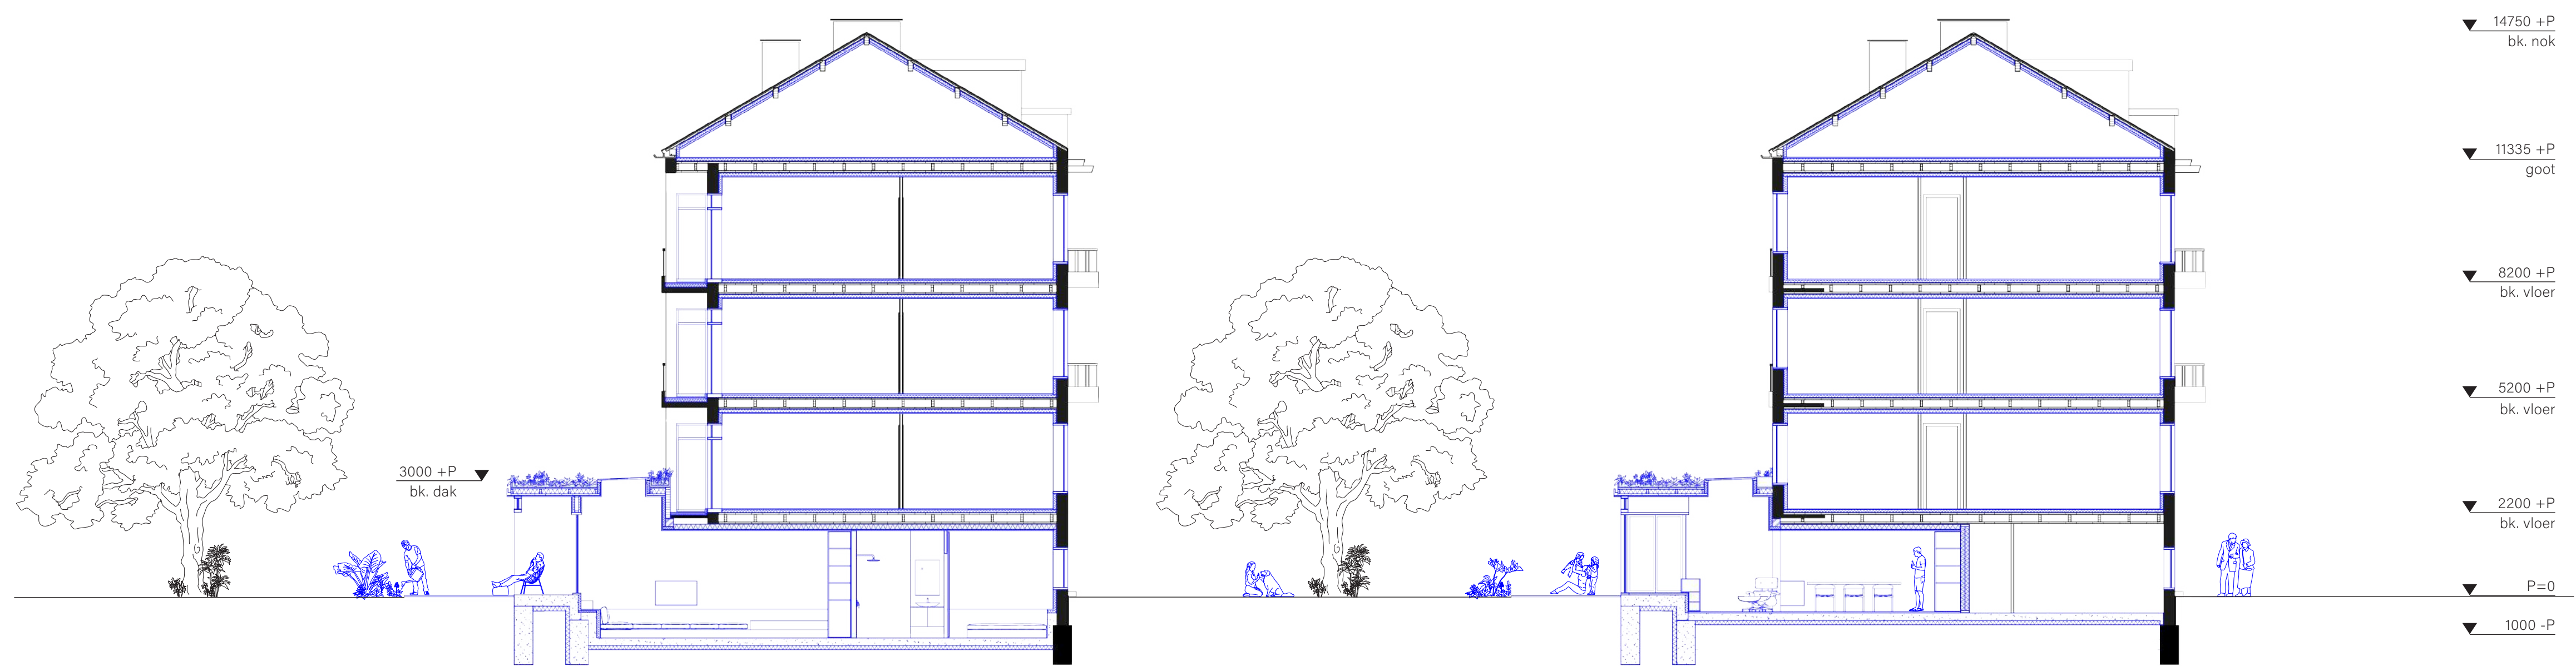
& 12 De voormalige speelruimtes op de begane grond verdieping ("onderhuizen"), zijn niet meer in gebruik zoals ze voorbestemd zijn. Tegenwoordig liggen er wat verloren spullen. Een geschikte ruimte om te verdichten. Door plaatstelijke funderingsbalken is er een dynamische plattegrond ontstaan.
